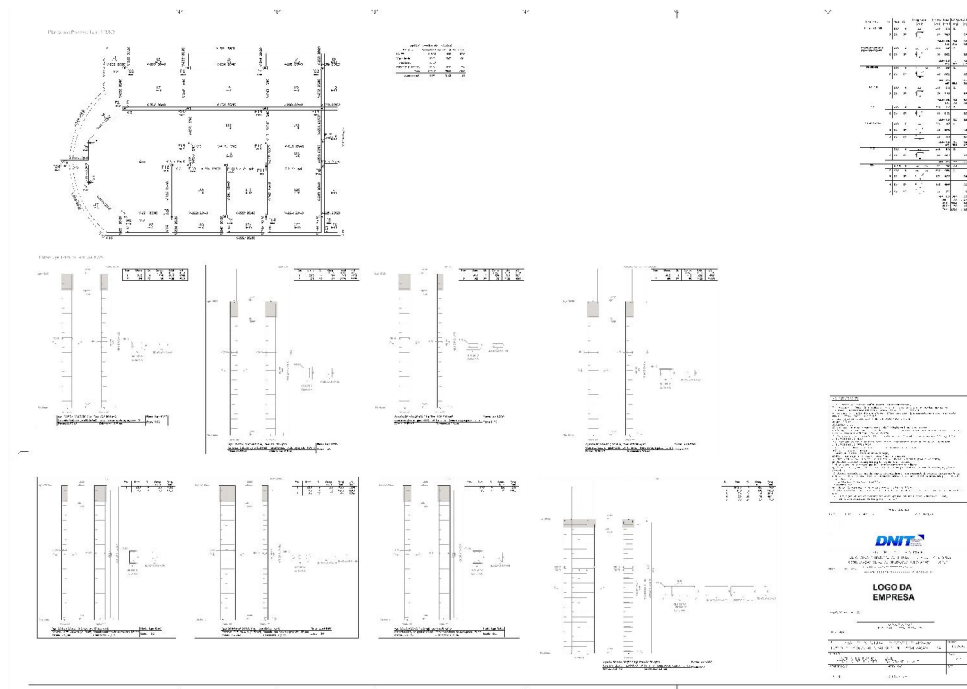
Planta de formas – laje e desenho de pilares - baldrame a laje.
